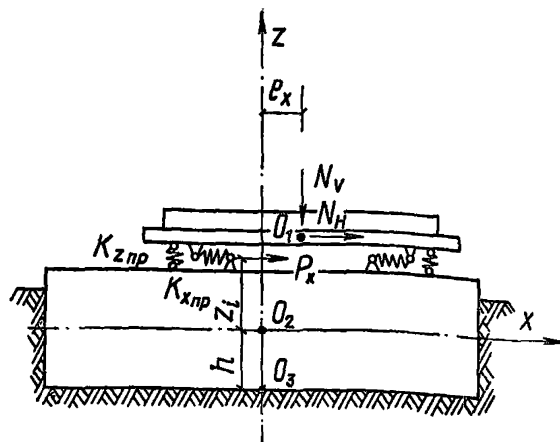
Схема установки на фундамент виброплощадки с круговыми колебаниями
